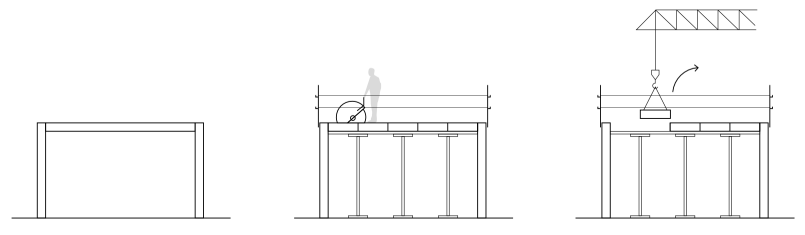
Méthode de déconstruction d'une dalle de béton par sciage, (immeuble de Lancy GE par Belastock en 2018).
